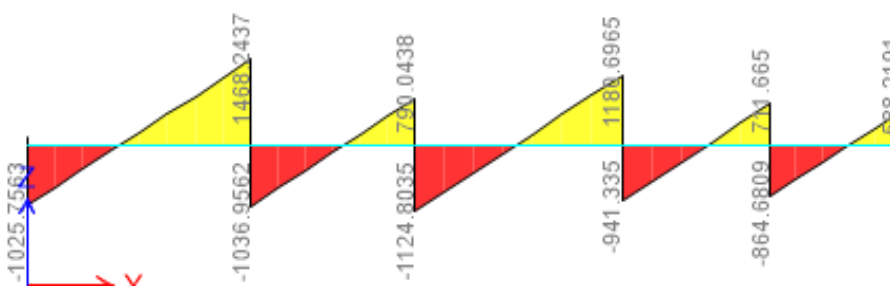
Diagrama de fuerza cortante en la losa aligerada 1
